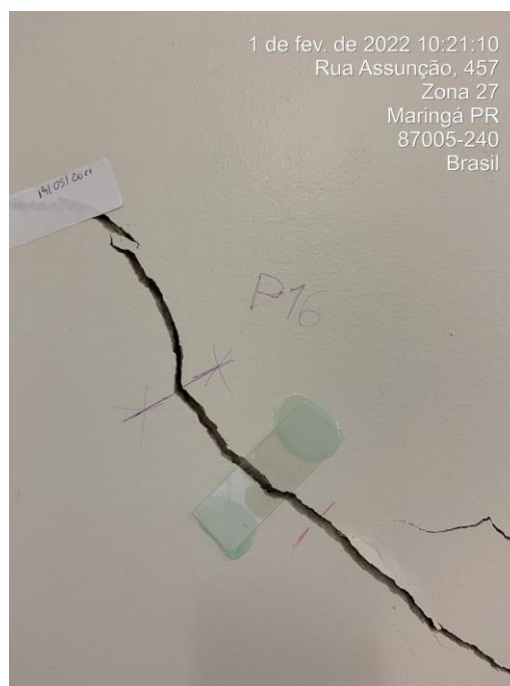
Vista da aplicação de placa de vidro para monitoramento de abertura de fissuras.
